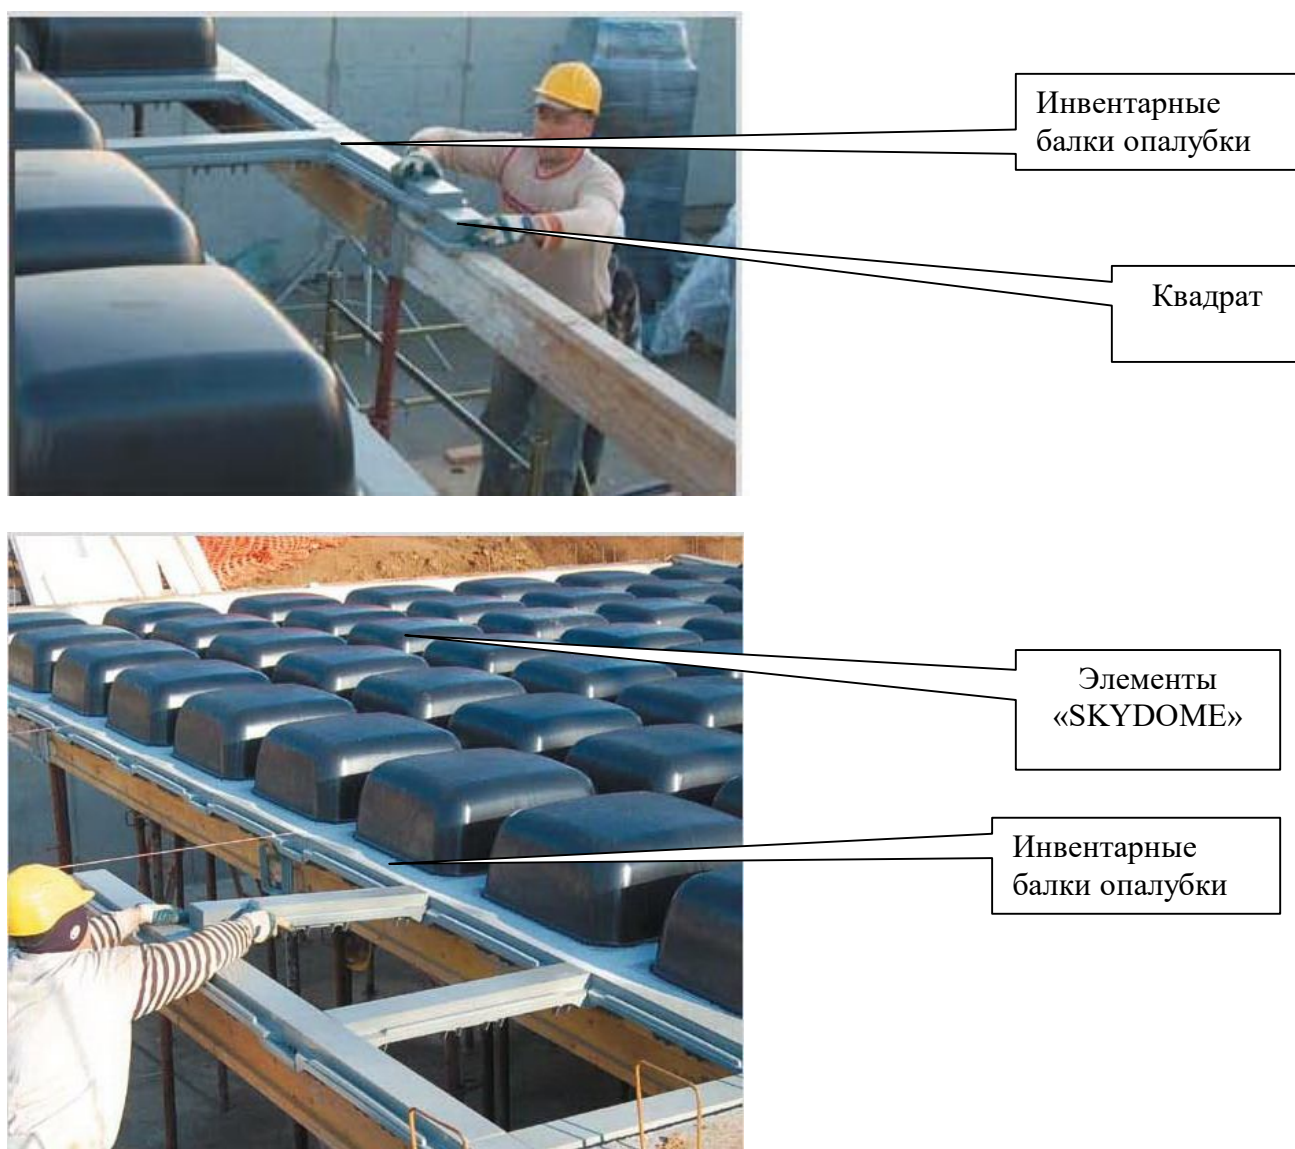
Установка инвентарных балок опалубки по несущим прогонам
